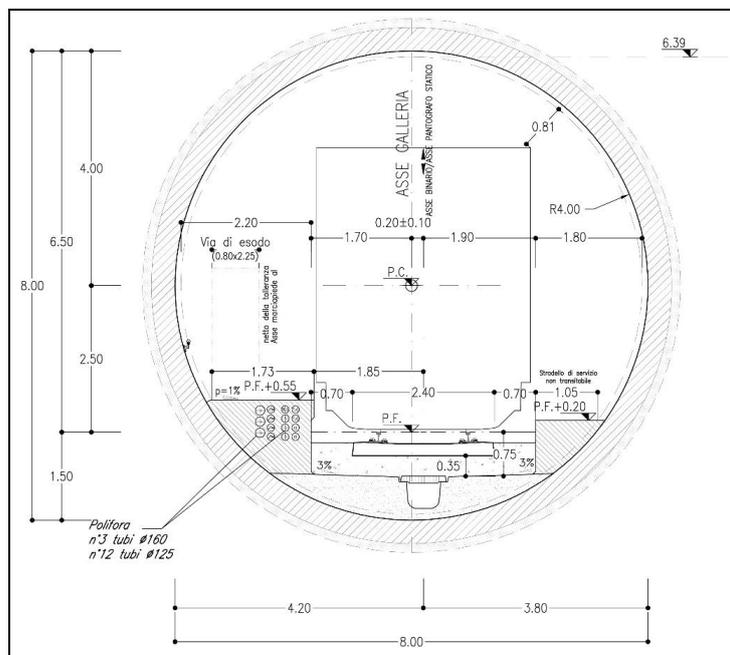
Sezione di intradosso galleria di linea a singolo binario in scavo meccanizzato (sezione corrente)
